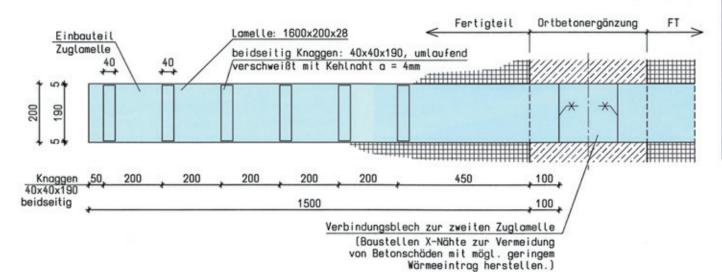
Details stählerne Zuglamelle Details steel tension plate
